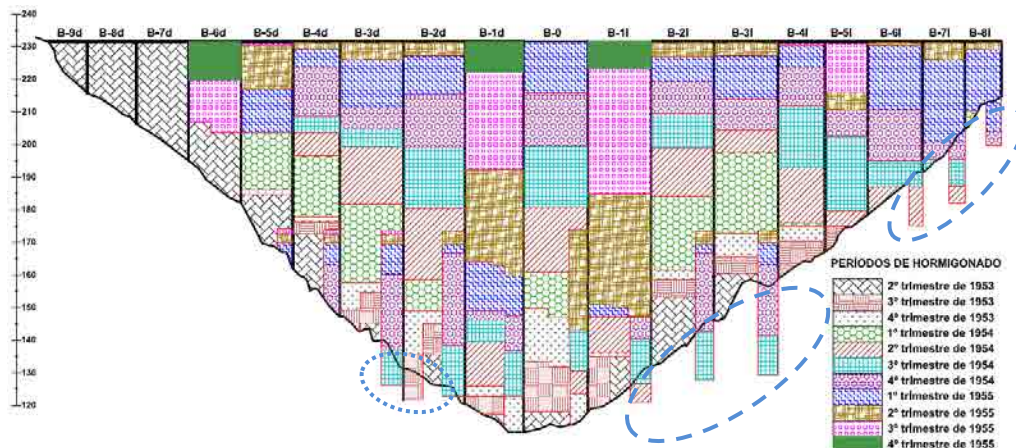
Plano de hormigonado de la presa por trimestres
